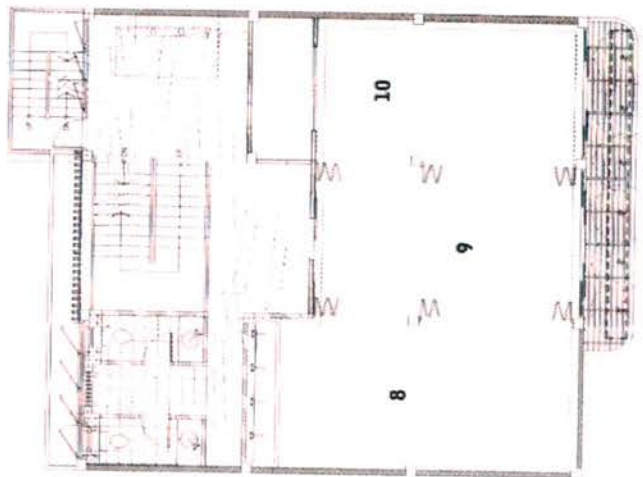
แสดงส่วน 1th Floor Plan
